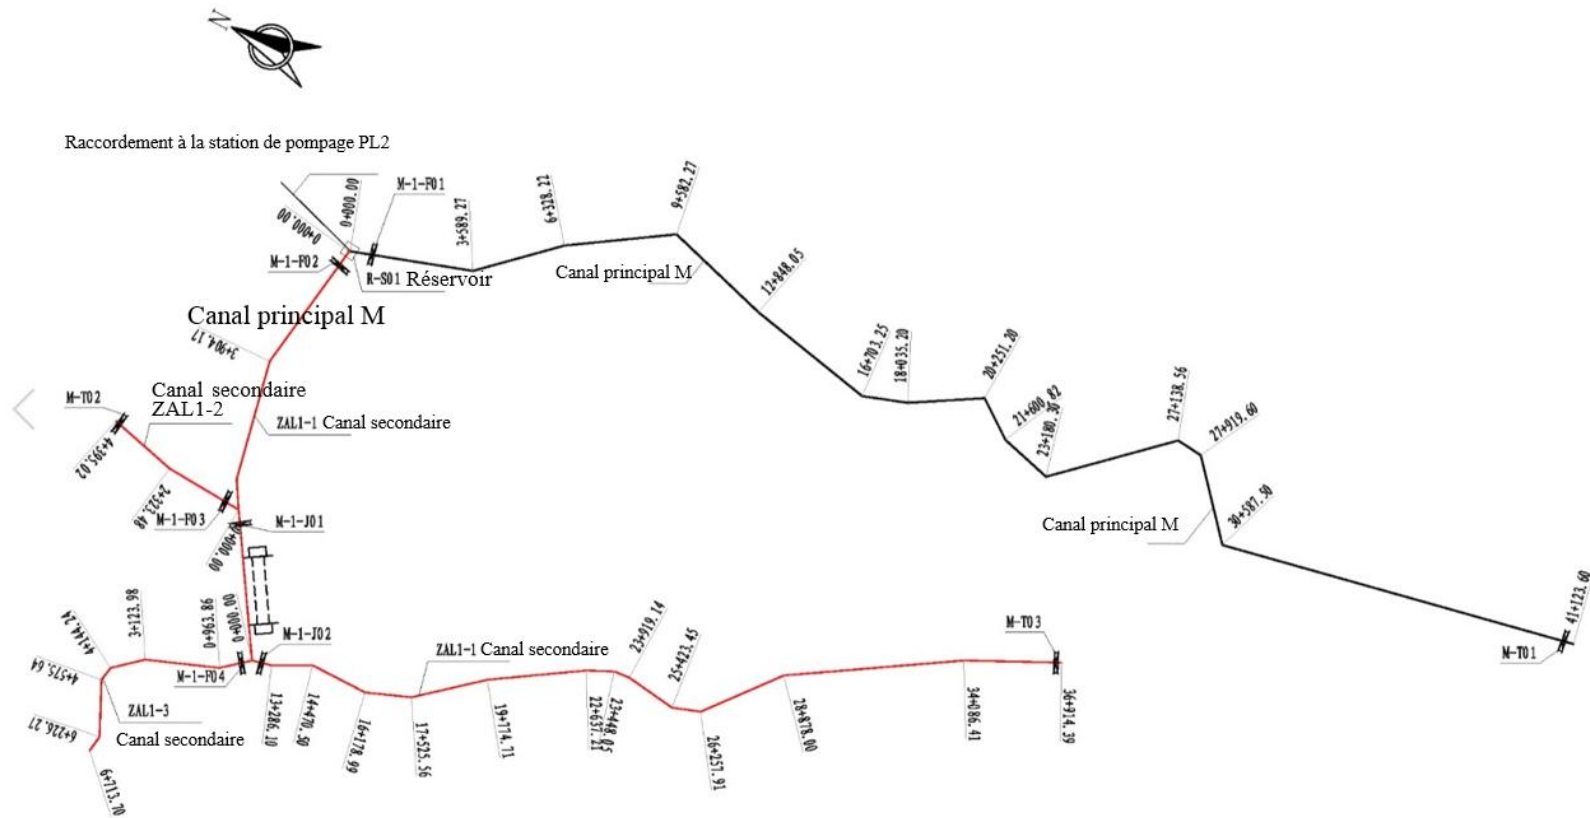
Plan d'aménagement des canaux dans la zone Ouest II
